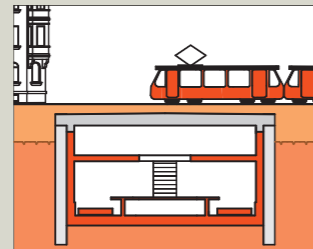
Betonieren des Bahnofsabschnitts im Bereich der Deckelbauweise. Betonieren des westlichen und östlichen Bahnofsabschnitts.
